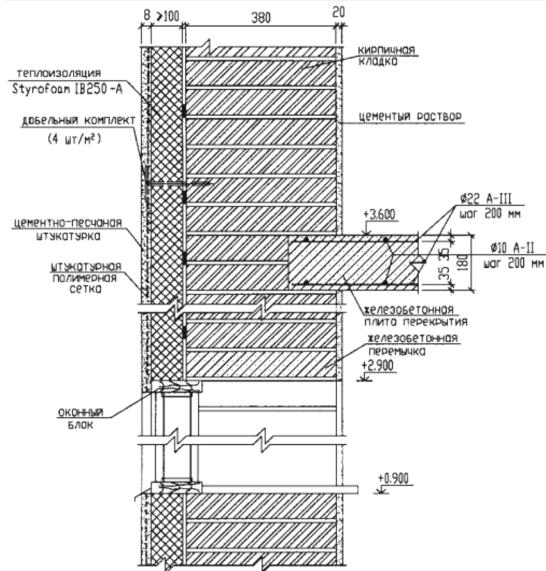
Несущая наружная стена здания высотой до 15 м
